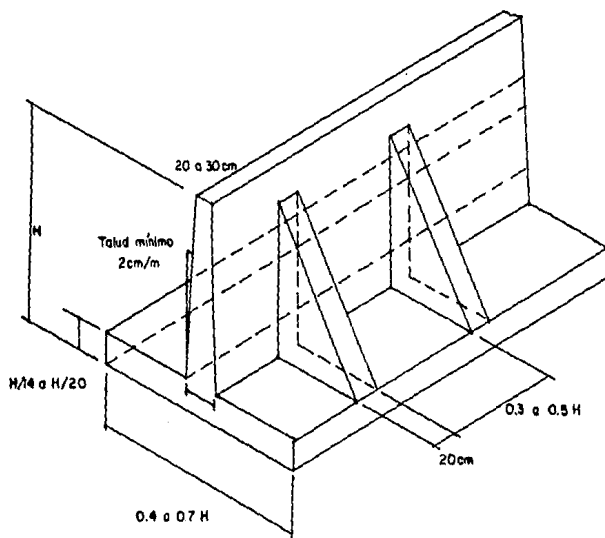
Dimensiones tentativas de un muro en contrafuerte
